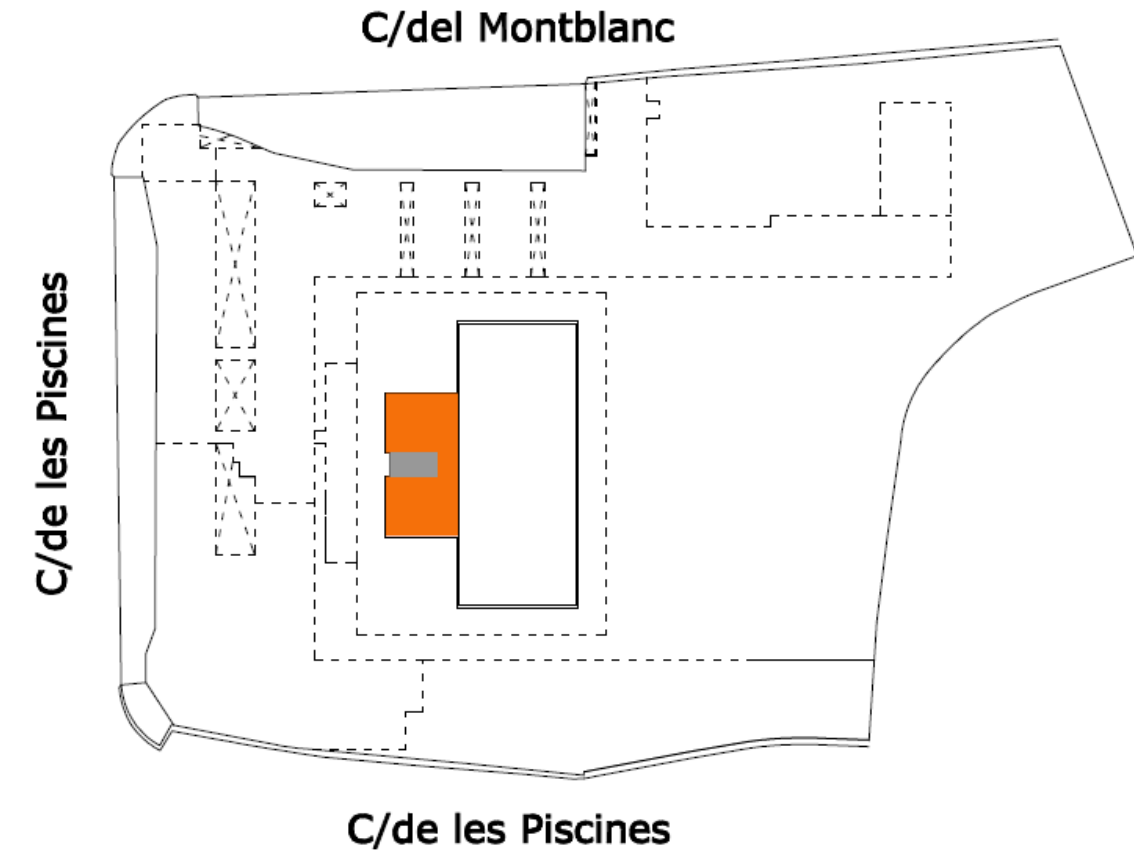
Esquema de la Planta Inferior de la Piscina
